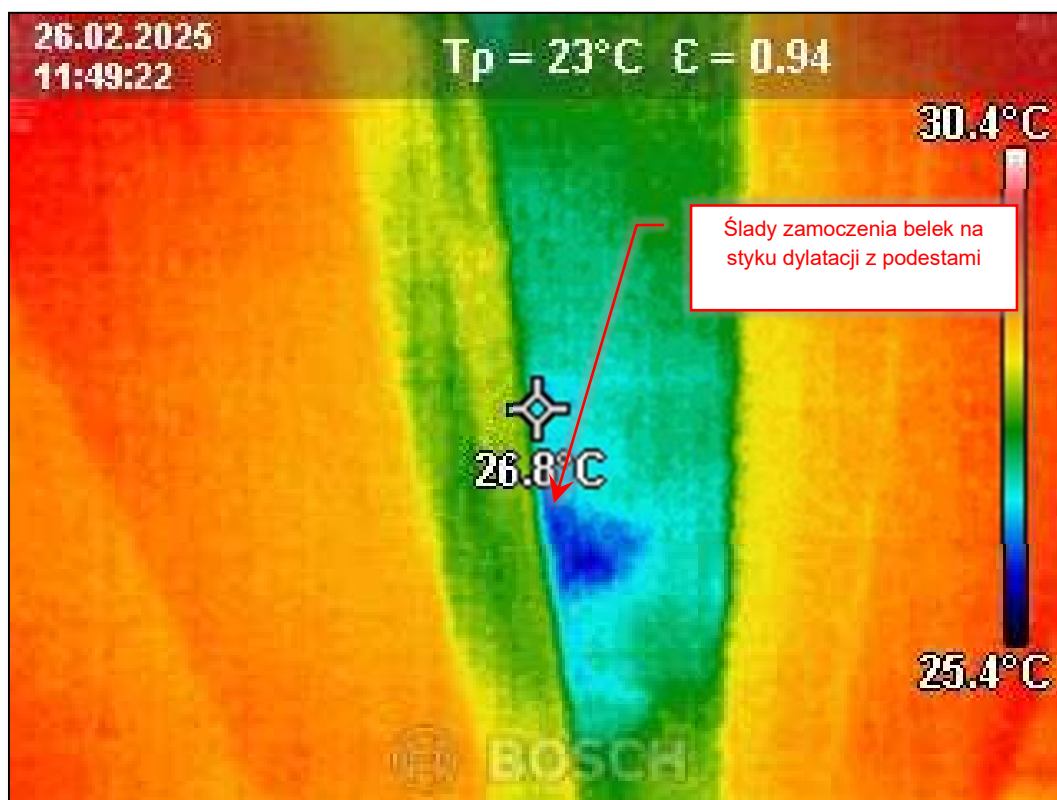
Inwentaryzacja zawilgocenia konstrukcji na skutek przerwania hydroizolacji. (fot. Rafał Fit)
